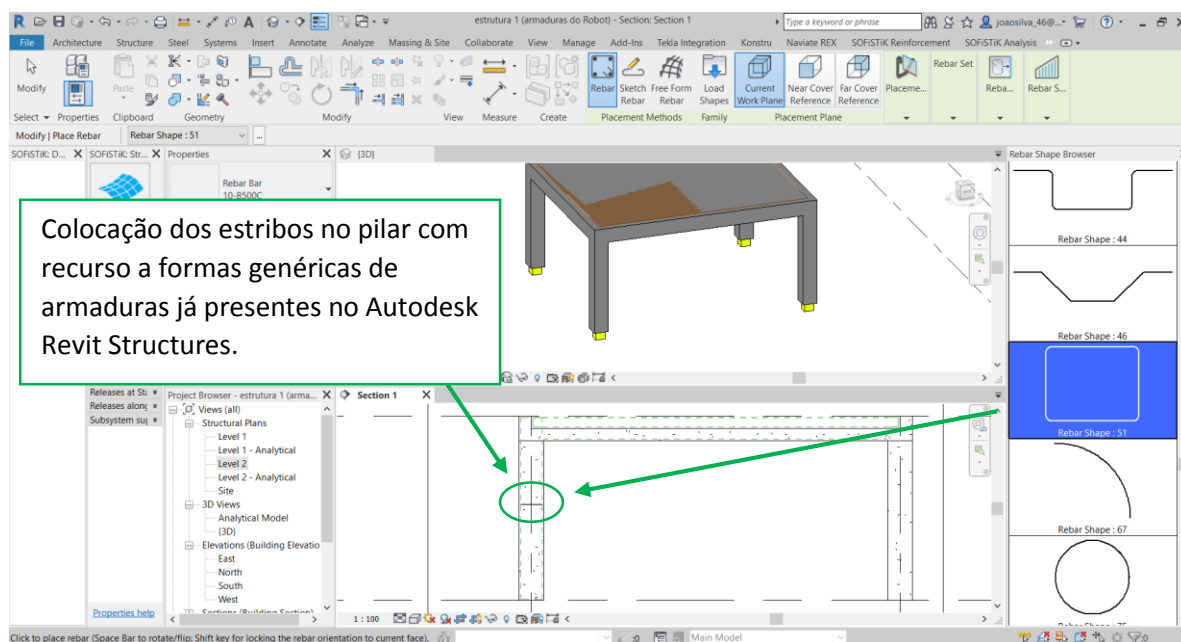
Modelação da armadura transversal de um pilar em Autodesk Revit Structures.
